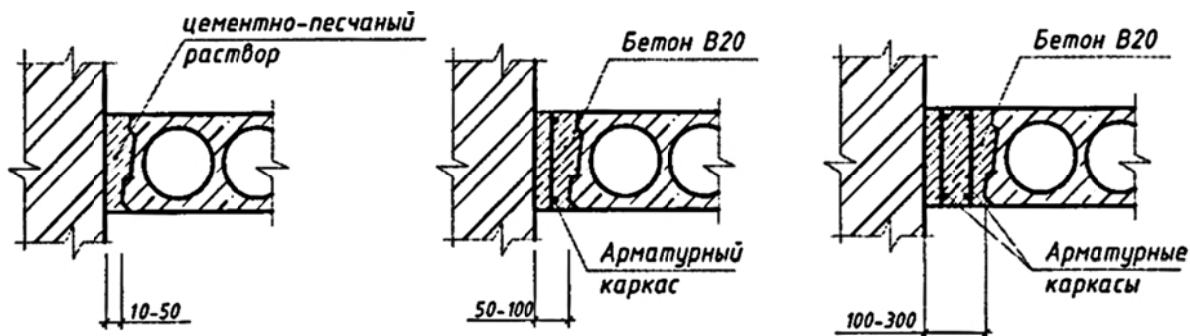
Узлы примыкания многопустотных плит к стенам
